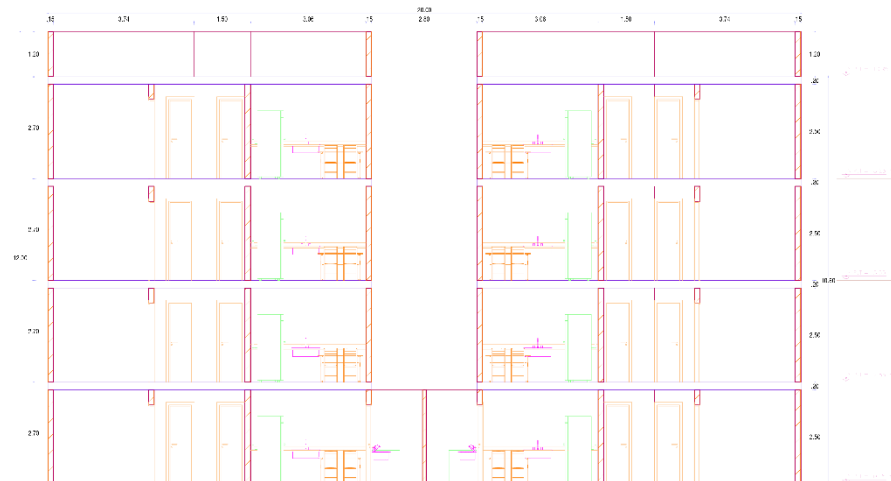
Plano Arquitectónico de Corte en Elevación A-A'.
